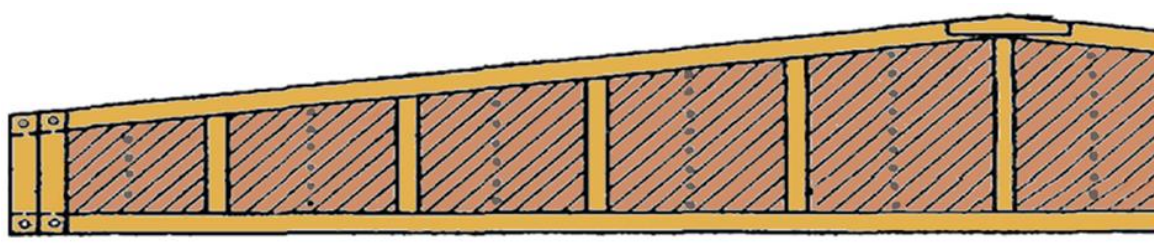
Двутавровая гвоздевая балка с перекрестной стенкой
